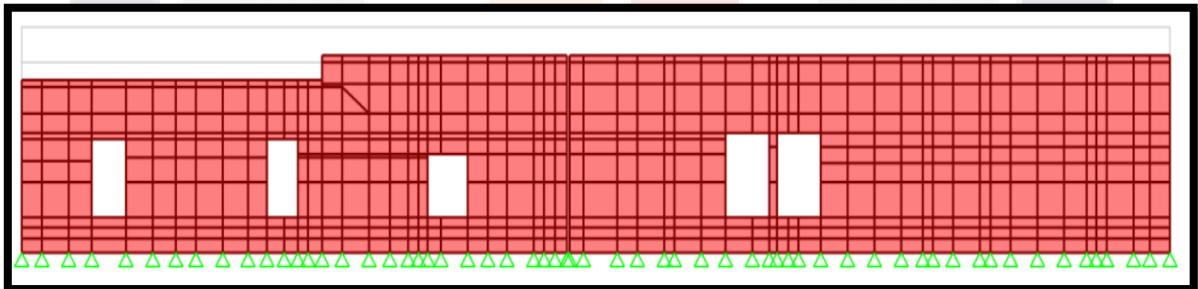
Modelo de elementos finitos (fachada lado sur). Fuente: elaboración propia
